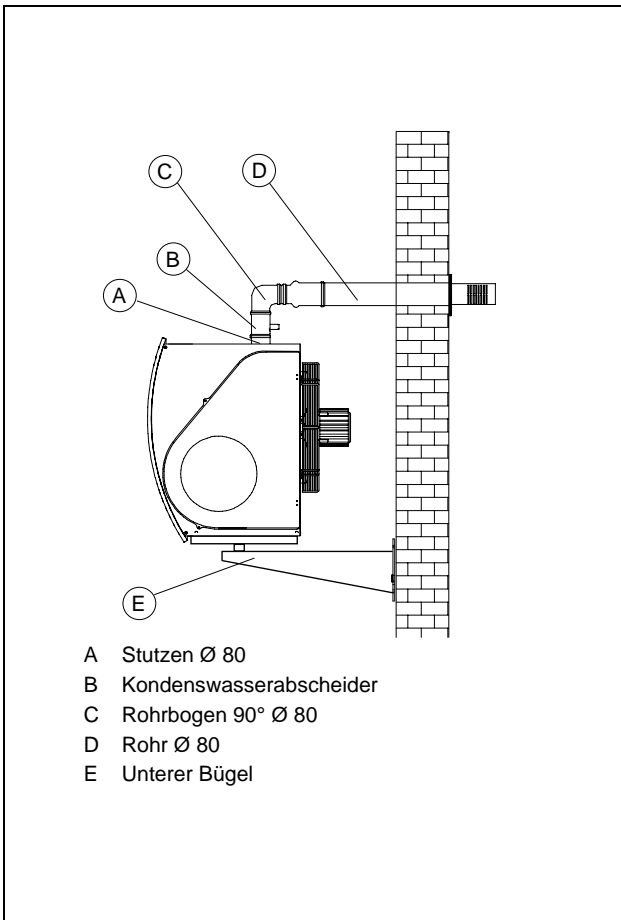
INSTALLATION TYP B23 MIT RAUCHABLEITUNG DURCH WAND
